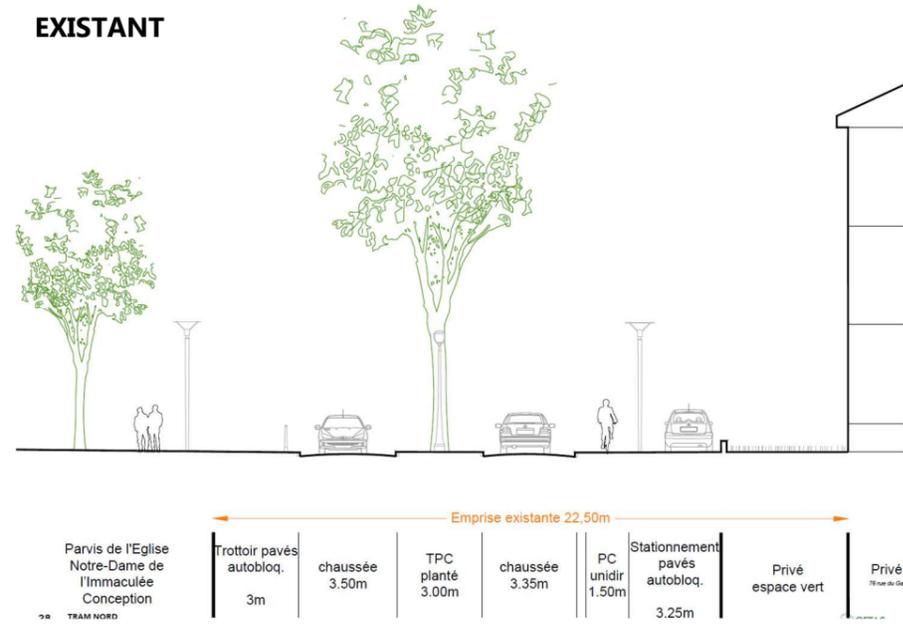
Plan de la route du Général de Gaulle Nord (source : AVP, GETAS 2023)
